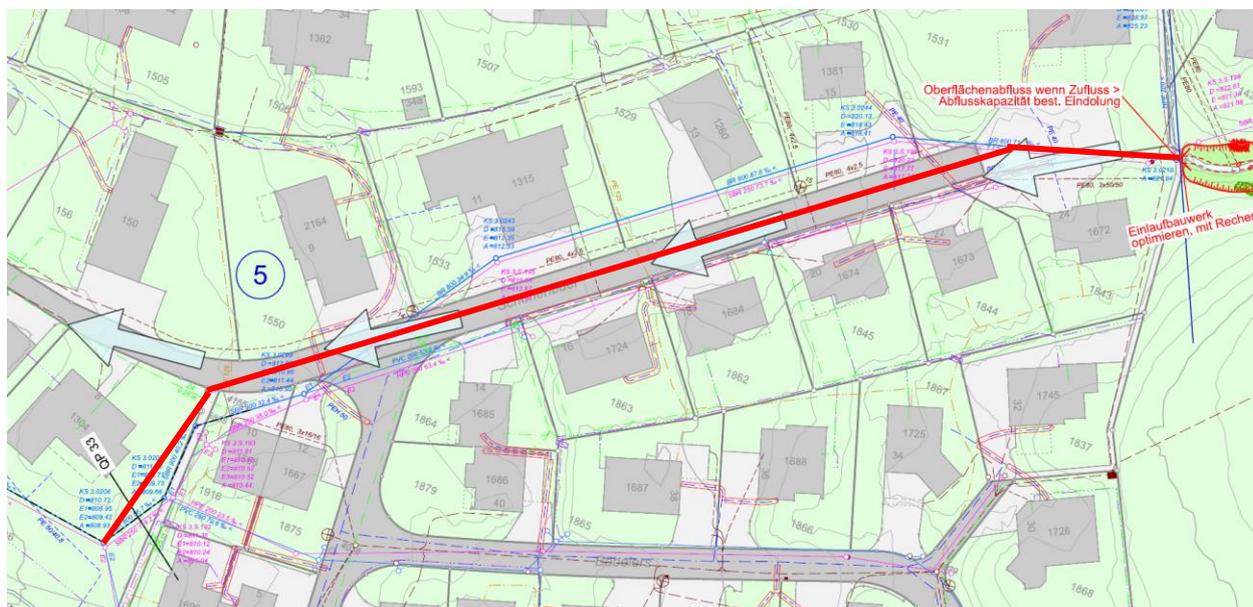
Ersatz der bestehenden Leitung durch einen Ortsbetonkanal mit Gitterrost
